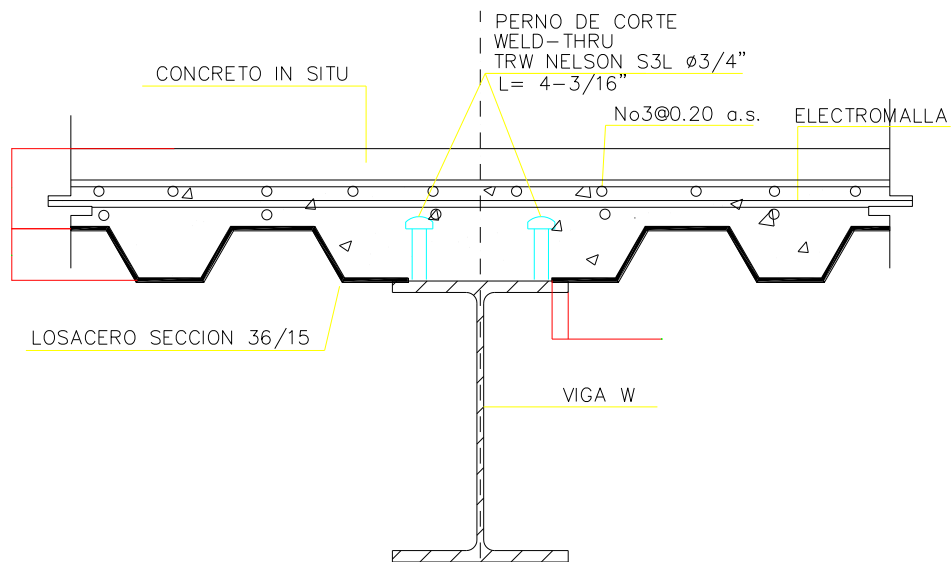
Vigas compuestas con formaletas Deck de acero
